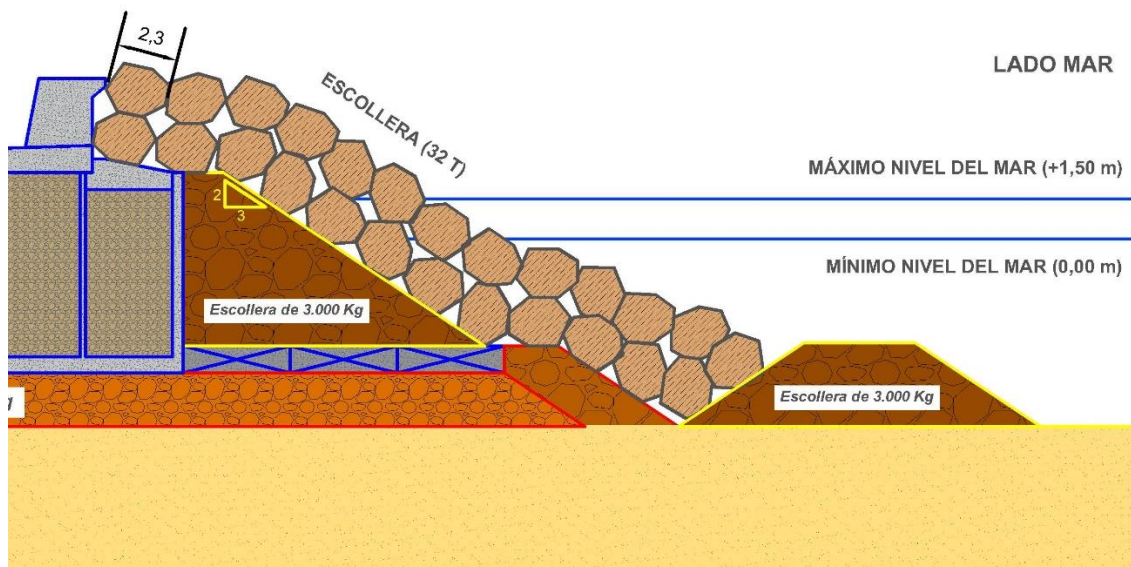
Sección tipo de la Alternativa C. Cotas en metros.
